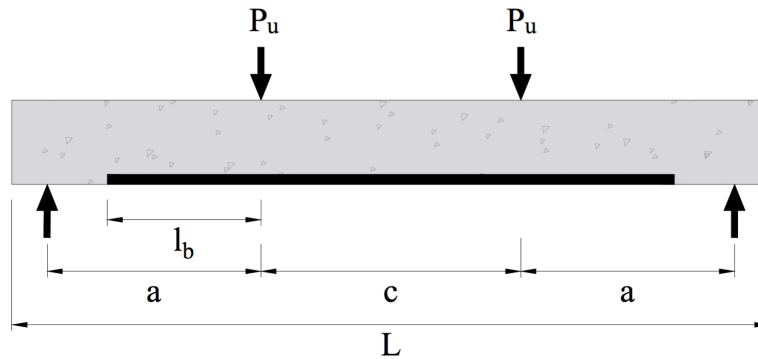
Mecanismo de aplicação de carga de vigas de concreto armado
